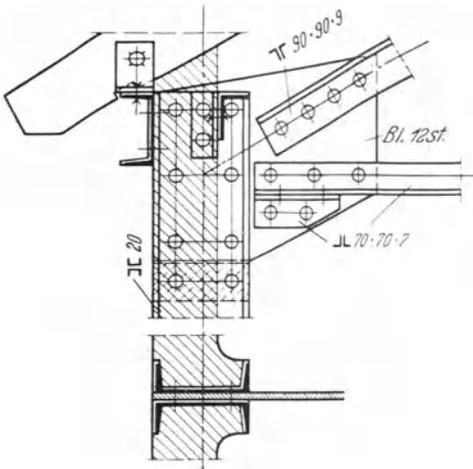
Binderanschlu an Stutze mit eingeschobenem Blech.
